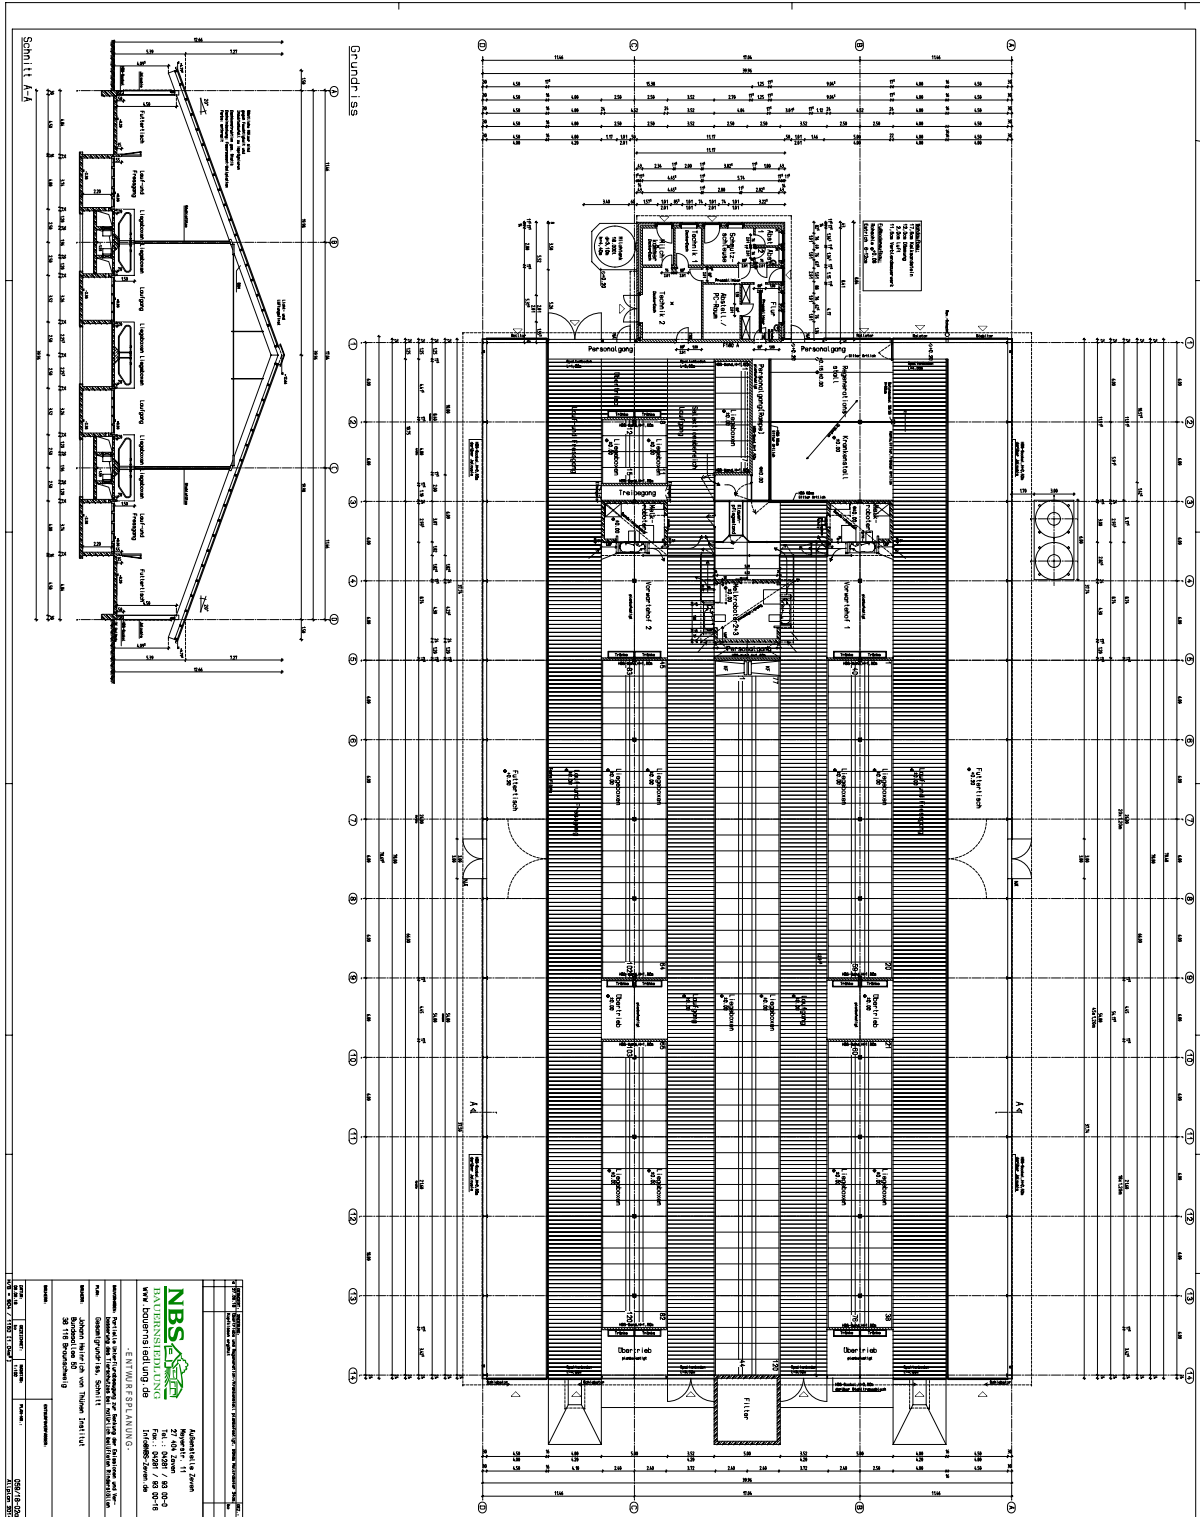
Grundriss und Schnitt Stallgebäude Version 01
